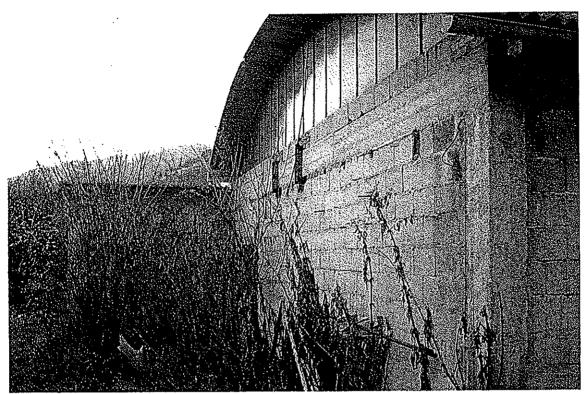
, veduta Sud-Ovest (fabb. A) porzione vecchia
